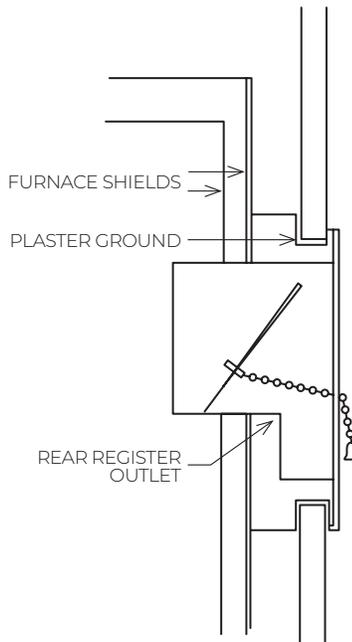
RETIRE LAS PLACAS DE TERMINACIÓN
